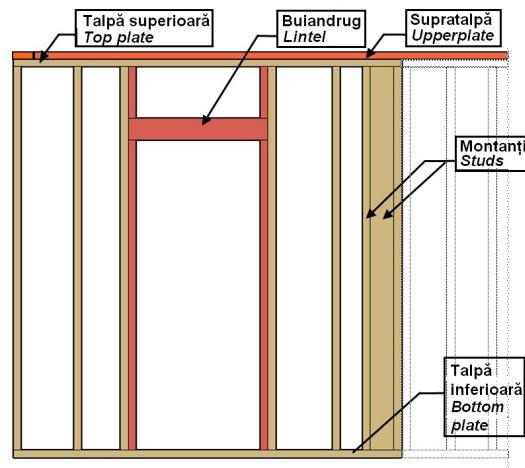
Schema constructivă a panoului de perete(element de rezistență a structurii framing/Wall panel's constructive scheme (framing structure strength element)).
